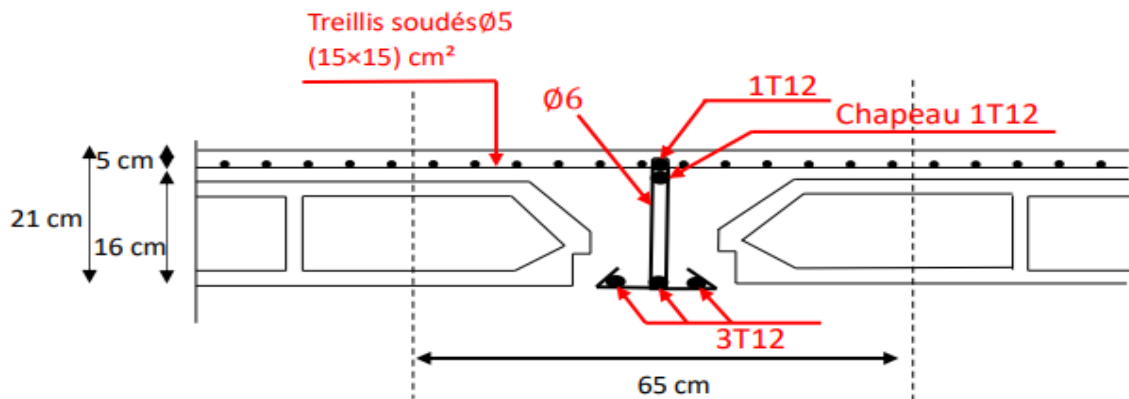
Schéma des ferrailages des poutrelles en appui
